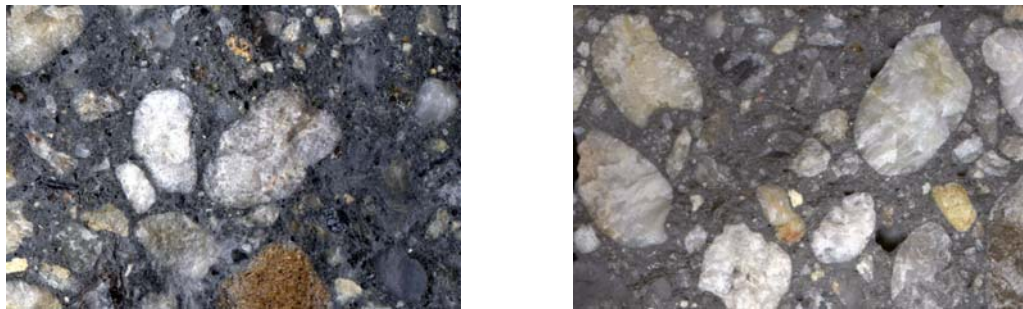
Foto einer Bruchfläche von hochfestem Beton a) statisch, b) dynamisch belastet
